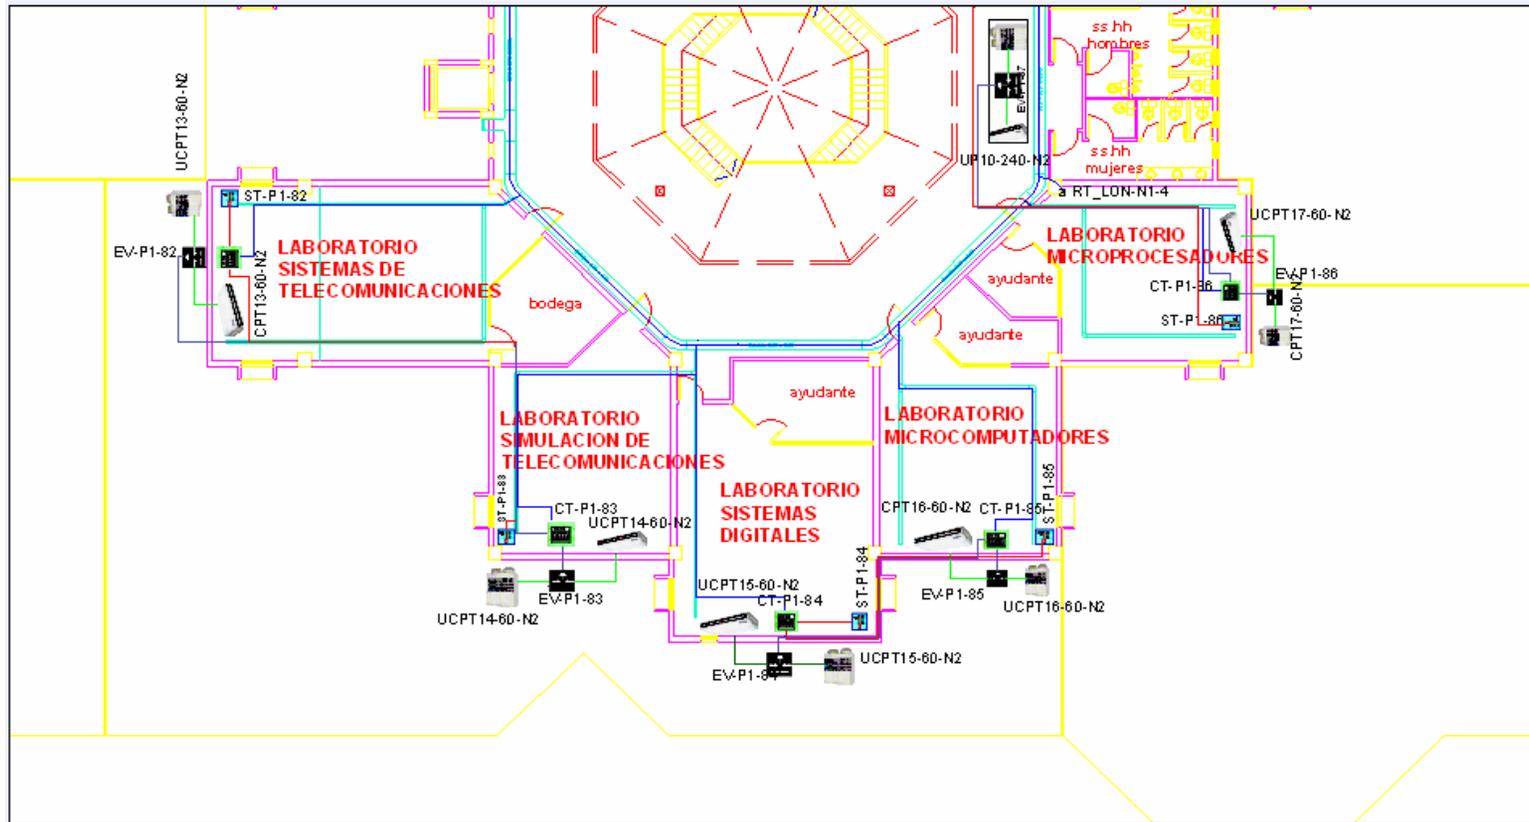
PLANO CLIMATIZACIÓN SEGUNDO PISO SECCION 2
